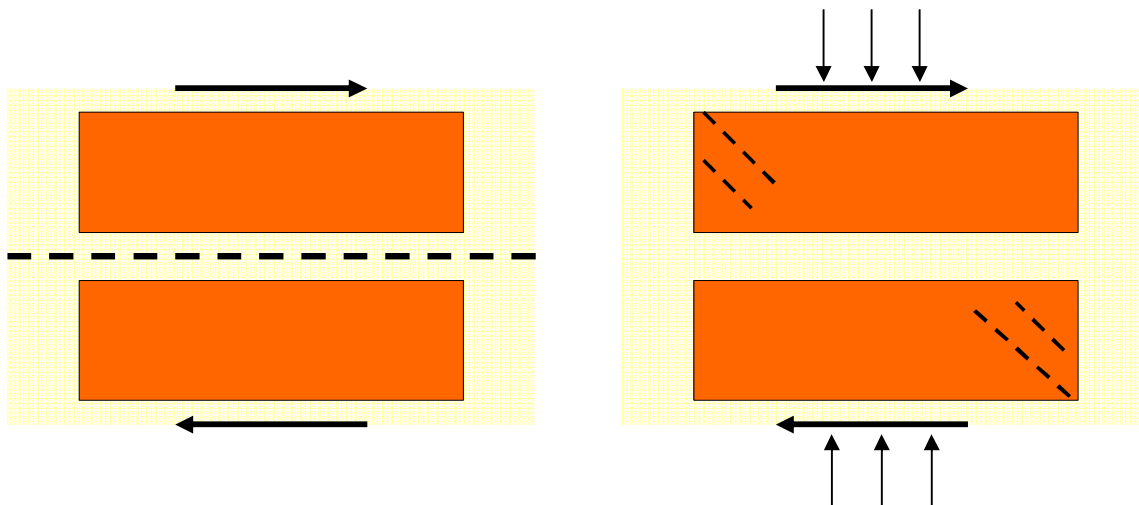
fissuration des joints et des blocs unitaires en cisaillement pur et combiné
